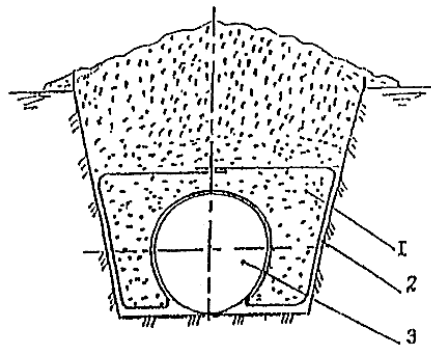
Способ балластировки газопроводов минеральным грунтом засыпки с использованием полотнищ из НСМ (для суглинистых грунтов и сельхозугодий) - схема 2: 1 - грунт засыпки; 2 - полотнище из НСМ; 3 - газопровод
